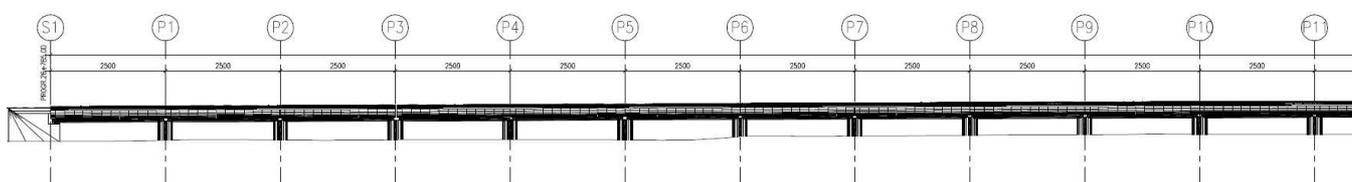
Viadotto Ripalta: stralcio del prospetto
